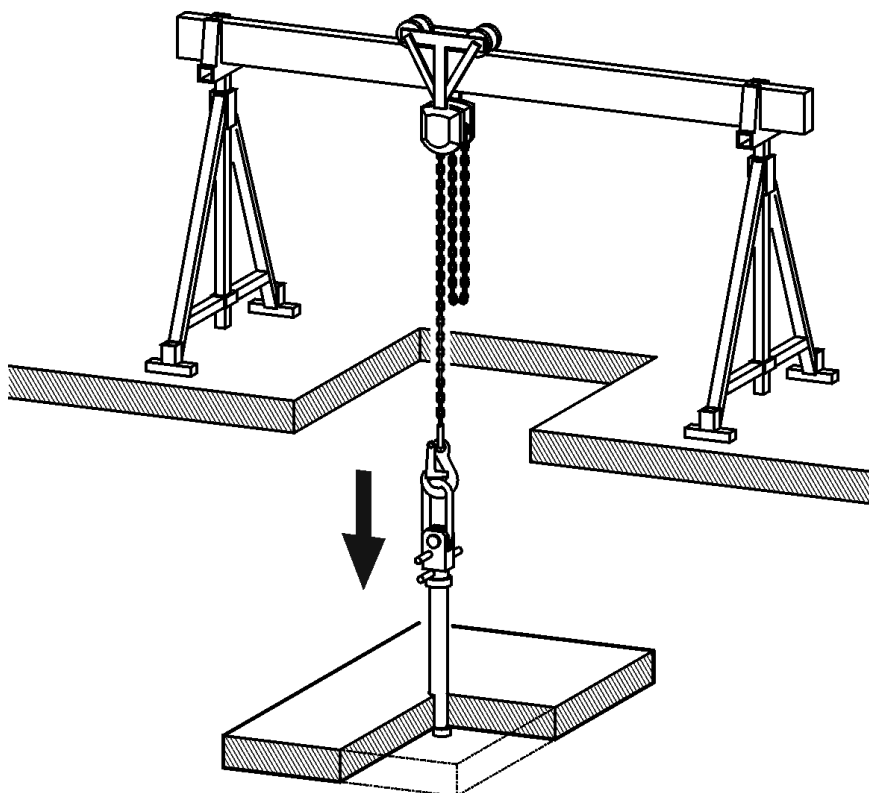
Verwijdering van wanduitzagingen met een betonbloklift
